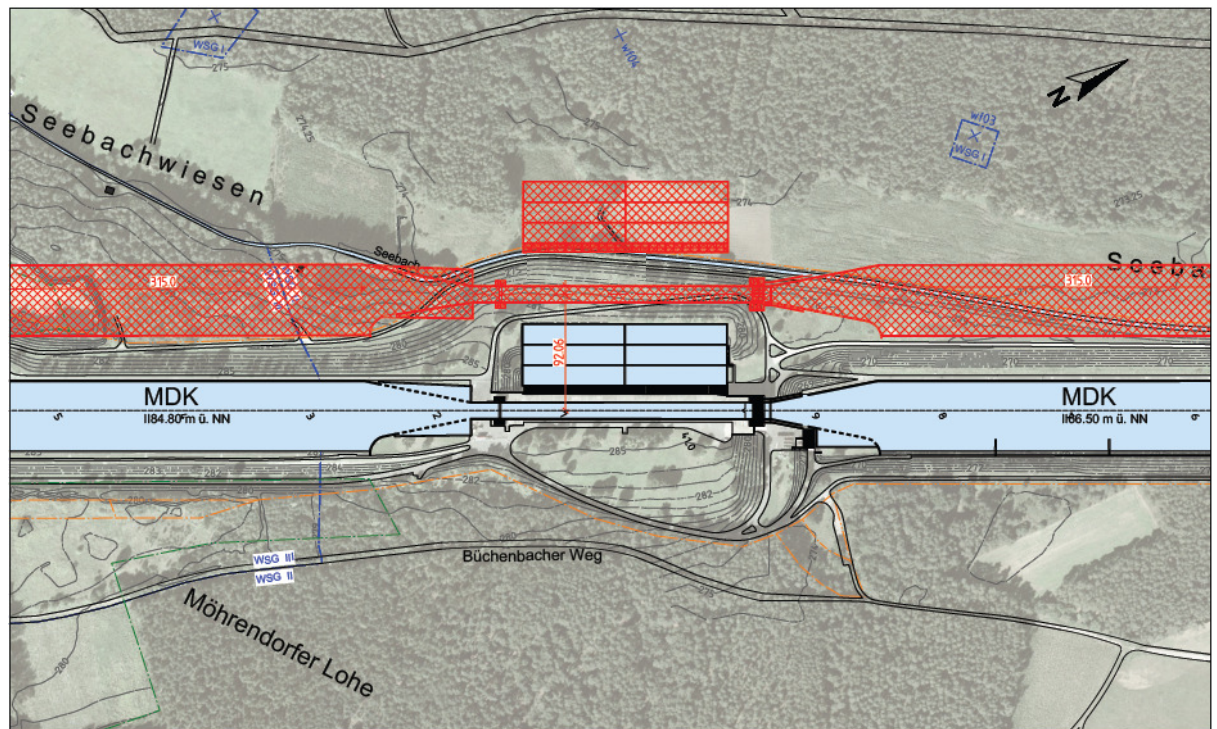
Schematische Darstellung der Variante C3 im Lageplan
